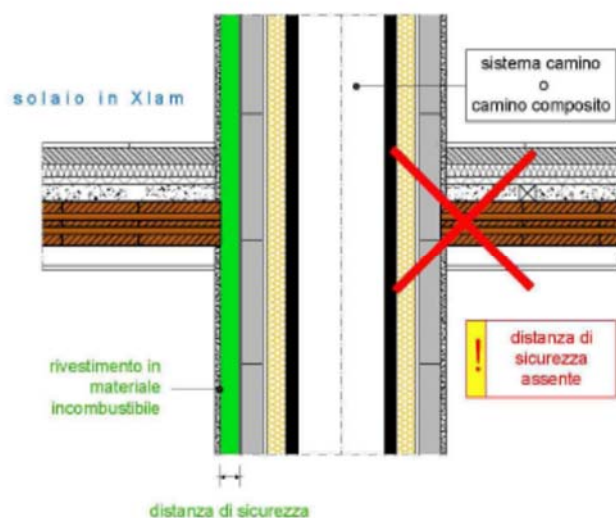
Esempio non corretto di attraversamento copertura Figura 7.27 – Esempio corretto di attraversamento copertura
